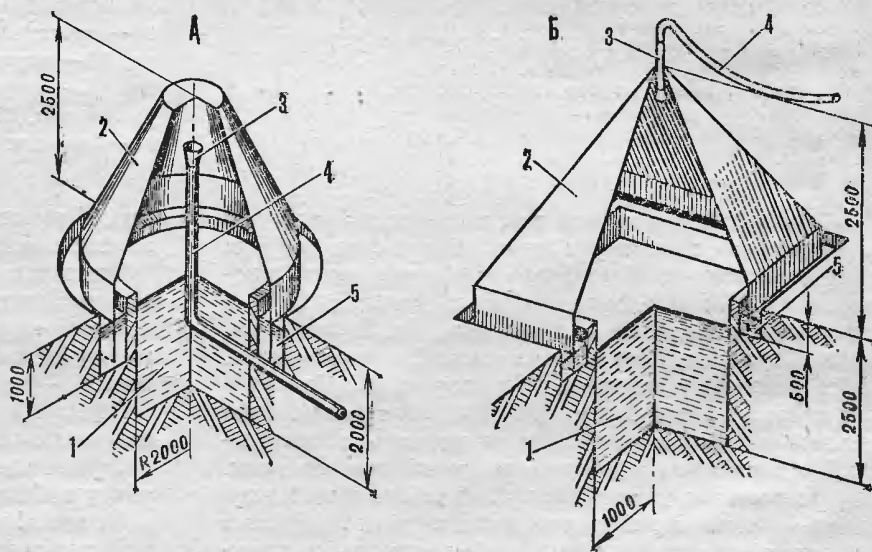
Схема установки для получения биогаза: А — с коническим колоколом, Б — с пирамидальным; 1 — яма ферментатора с сырьем, 2 — колокол, 3 — выпускной патрубок, 4 — трубопровод (шланг) подачи биогаза, 5 — канавка гидрозатвора с водой.
